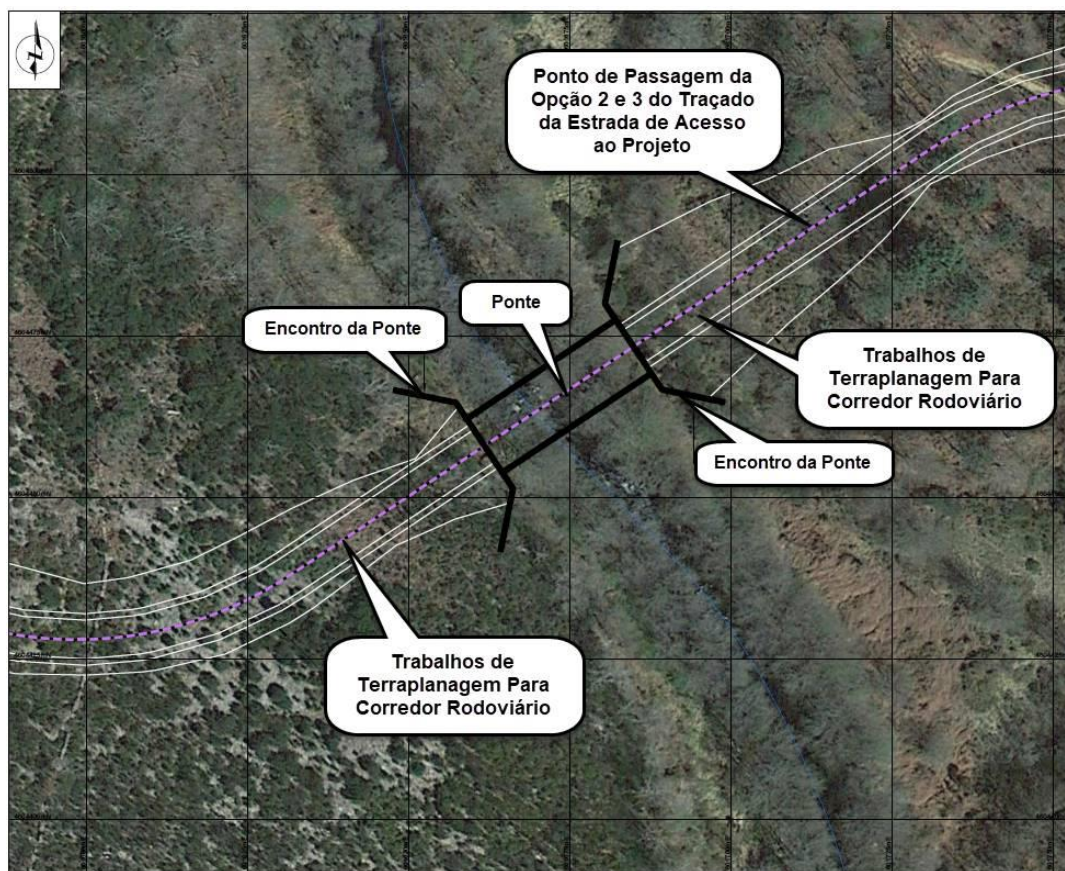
Desenho do traçado da estrada e da ponte para atravessar o Rio Beça.
